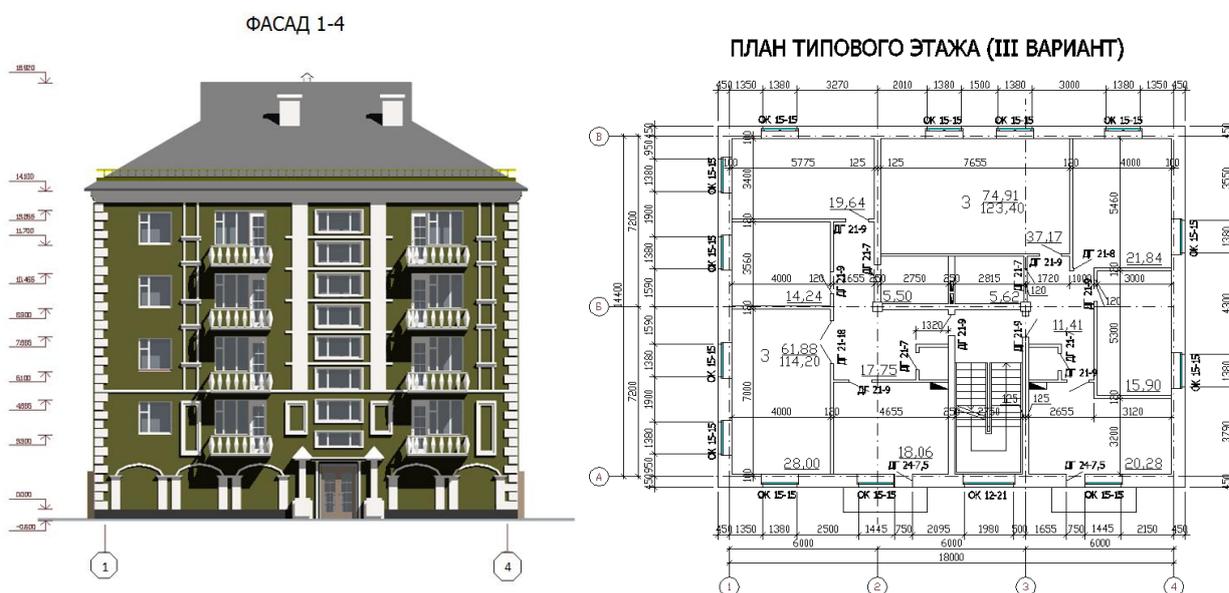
Фасад и план типового этажа одного из разработанных вариантов архитектурно-планировочных решений
